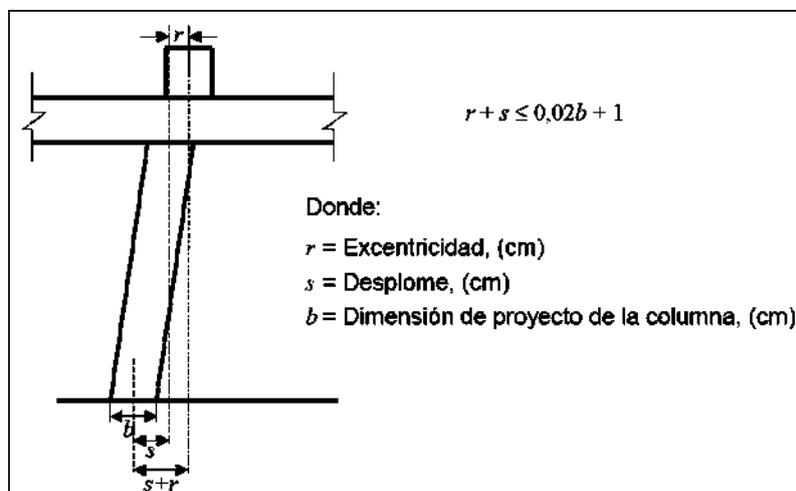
Tolerancia para excentricidad y desplome de columnas [16].
